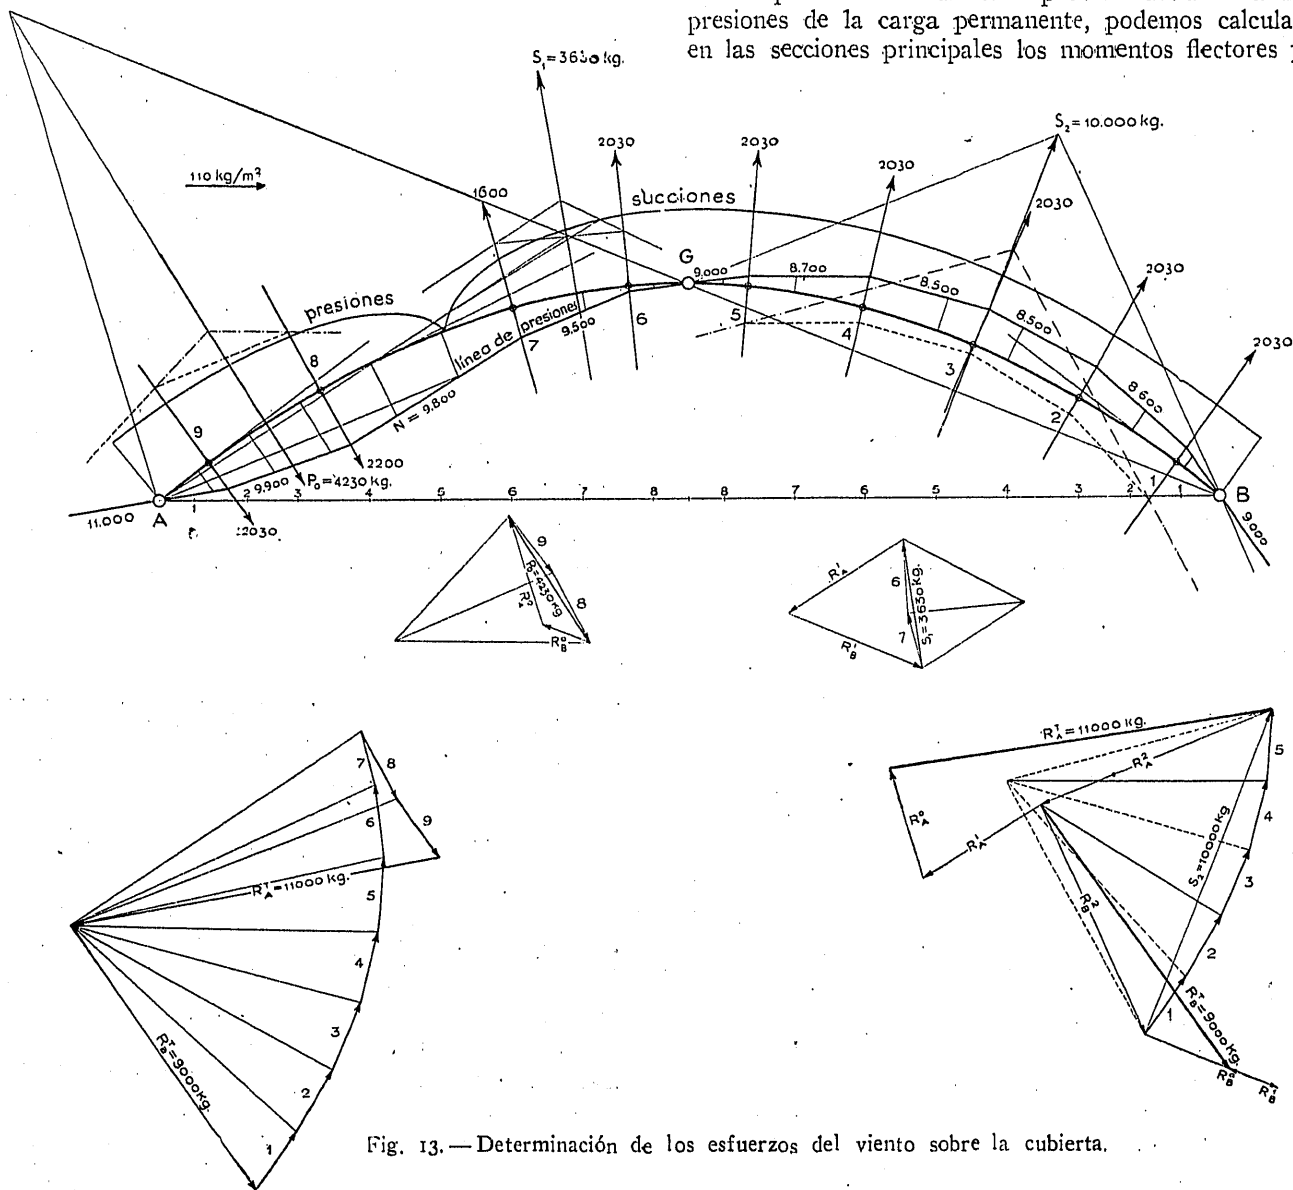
Determinación de los esfuerzos del viento sobre la cubierta.
